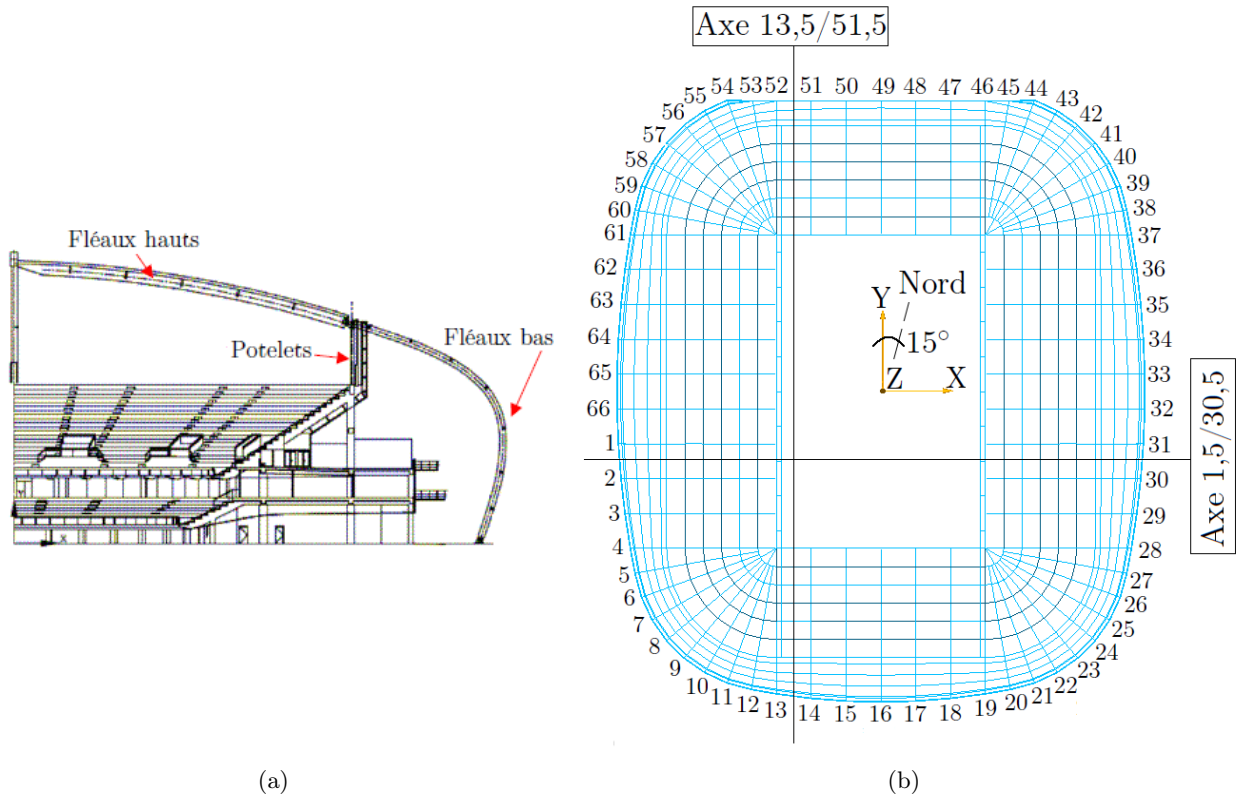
(a) Présentation du système structural : fléaux hauts, bas et potelets. Source : [7], modifiée.
